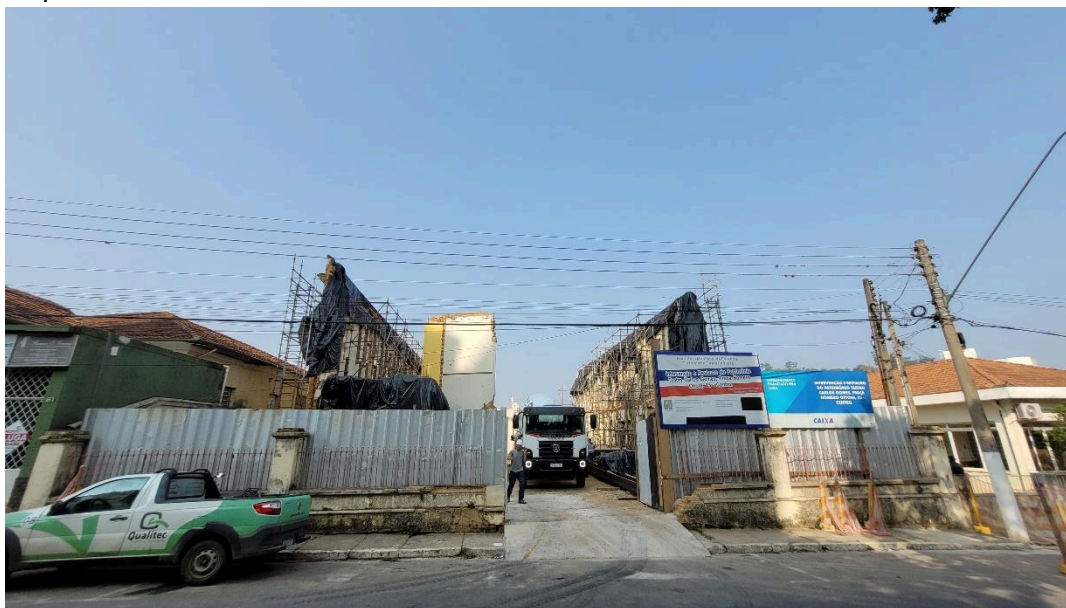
Vistoria 09/09/24 – Fechamento da obra em telha metálica, vista externa.
